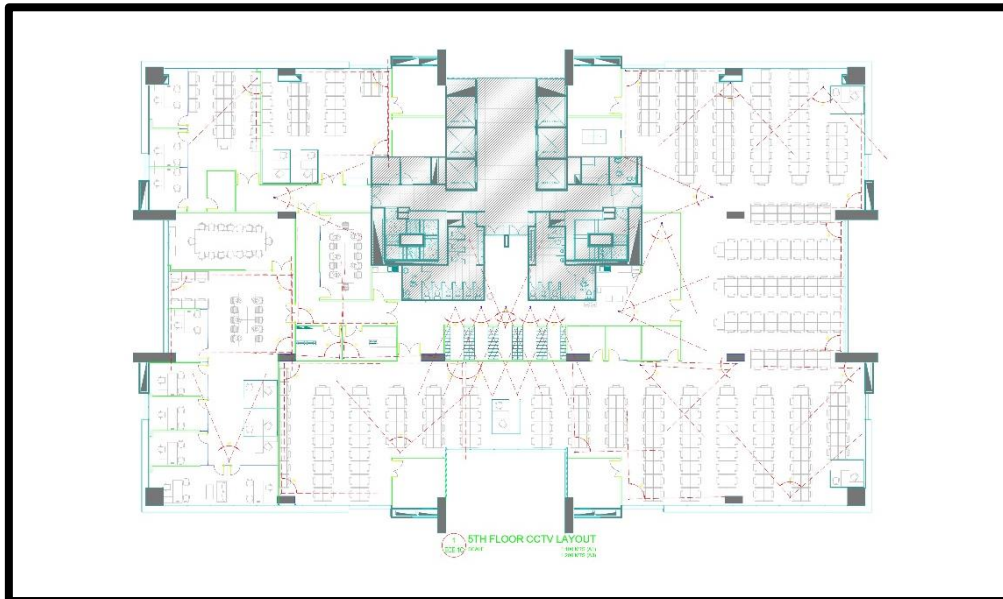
Punto de vista cámaras piso 5. (Green Ingeniería, 2019)
